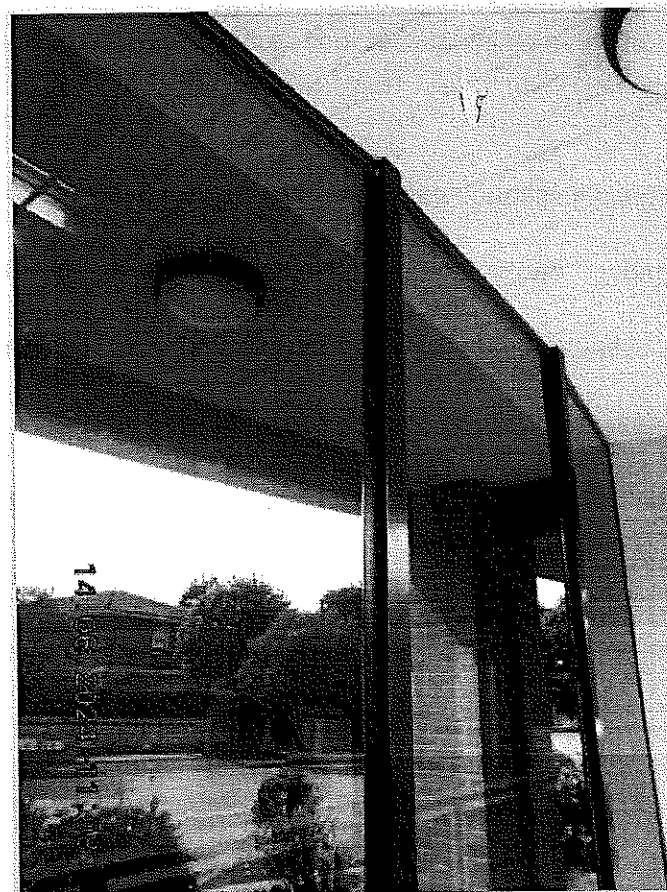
ALONI SU TRAVI SOFFITTO CAUSATE DA INFILTRAZIONI
